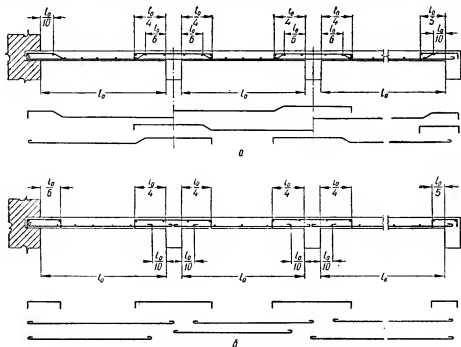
78. Армирование многопролетных балочных плит вязаной арматурой:
